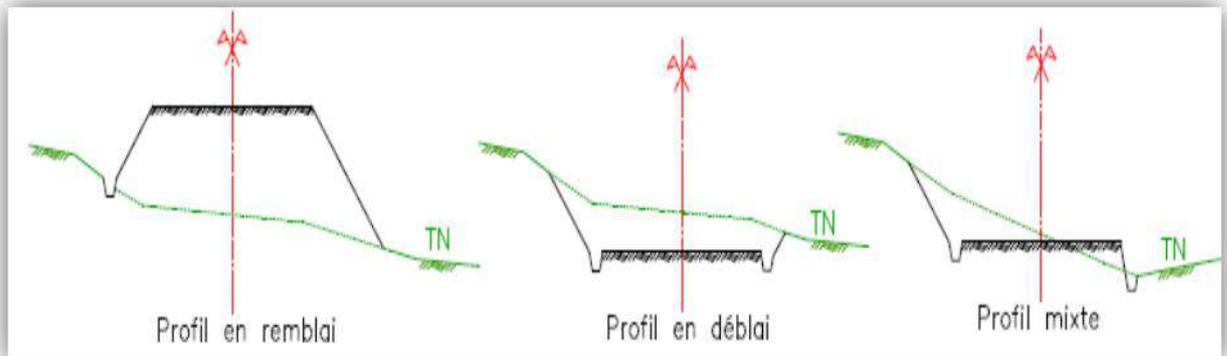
Types de profils en travers (Cas de remblai, déblai et mixte)
